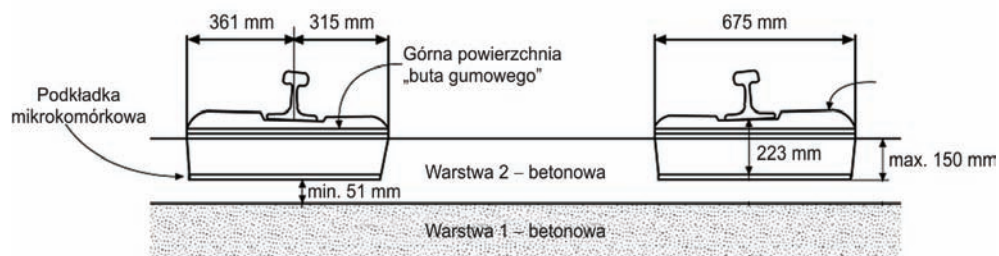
Konstrukcja nawierzchni typu SBB – BÖZBERG/STEDEF [25]
